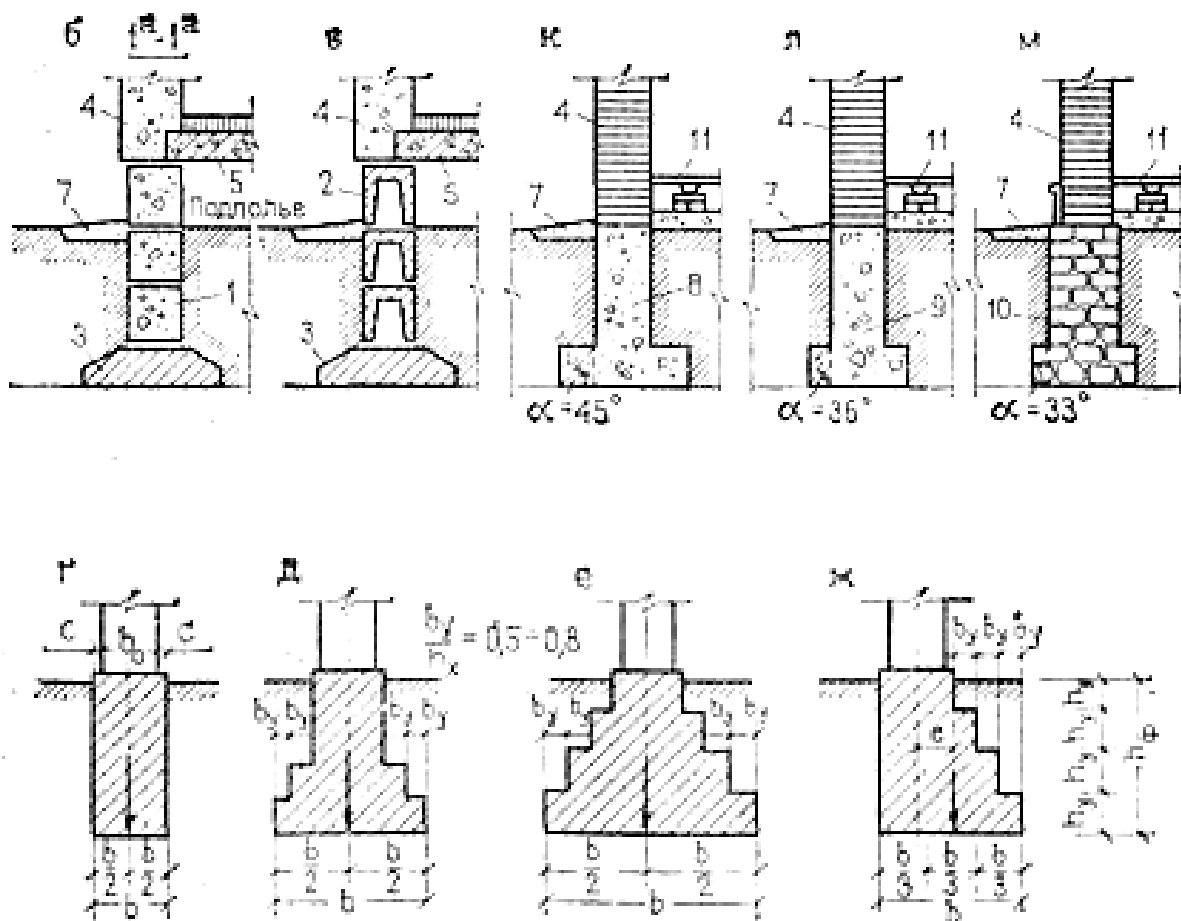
Стрічкові фундаменти: б, в - варіанти без підвалу з суцільних і пустотілих блоків; г, д, е - конструкція жорсткого фундаменту з мінімальною, звичайної і максимально розширеною підшовою; ж - несиметричний фундамент; і - перехід від однієї глибини закладення фундаменту до іншої; до, л, м, - варіанти стрічкових фундаментів з монолітного бетону, бутобетону та буту; 1 - стінові блоки підвалів; 2 - пустотні стінові блоки підвалів; 3 - фундаментні подушки; 4 - стіни; 5 - перекриття; 6 - підлоги підвалу; 7 - вимощення; 8 - бетонний фундамент; 9 - бутобетонний фундамент; 10 - бутовий фундамент; 11 - підлогу першого поверху.
